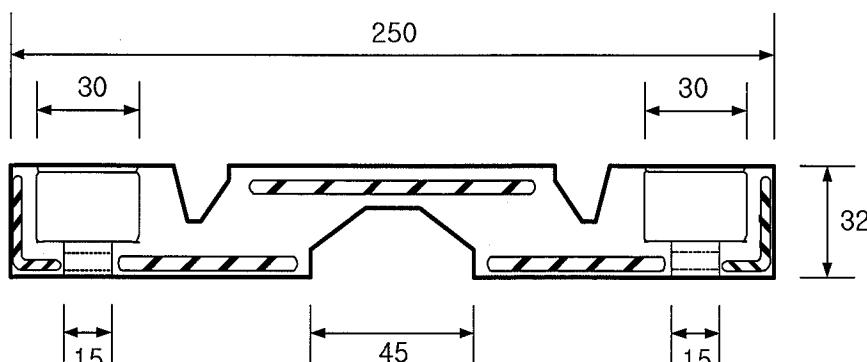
Transflex Joint의 단면도 (단위 : mm)
